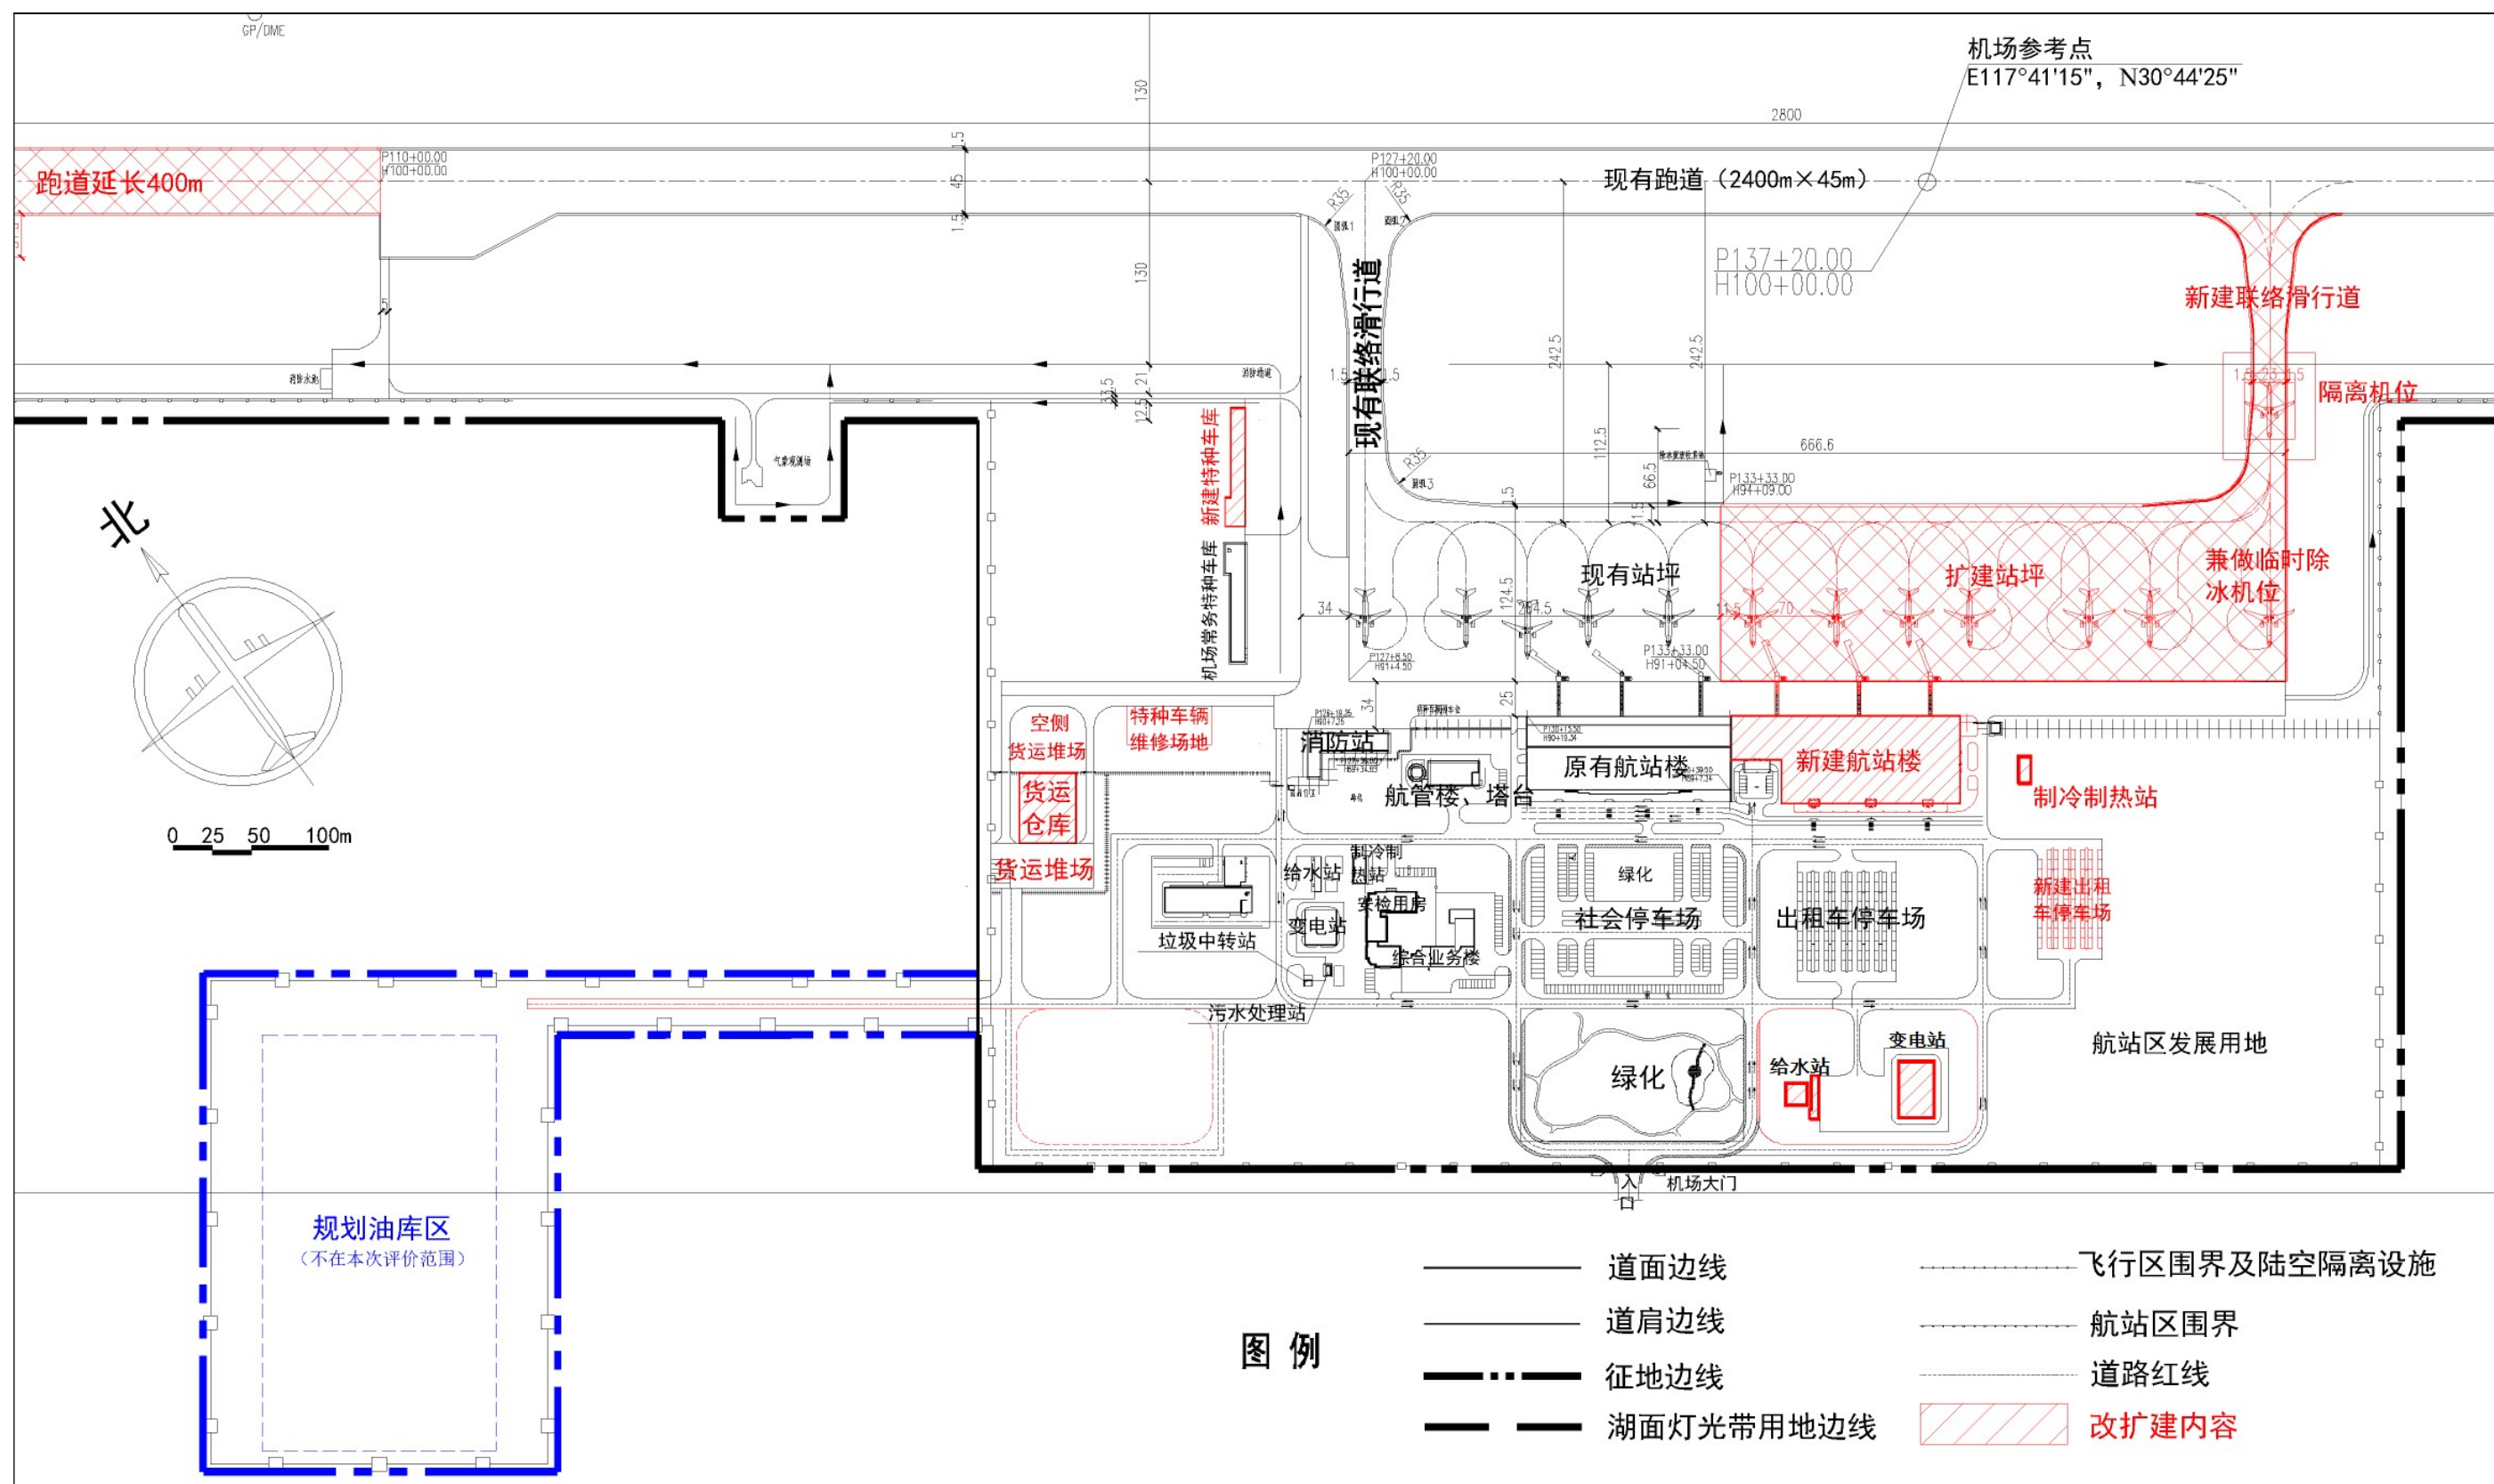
池州九华山机场改扩建后航站楼总平面布置图
